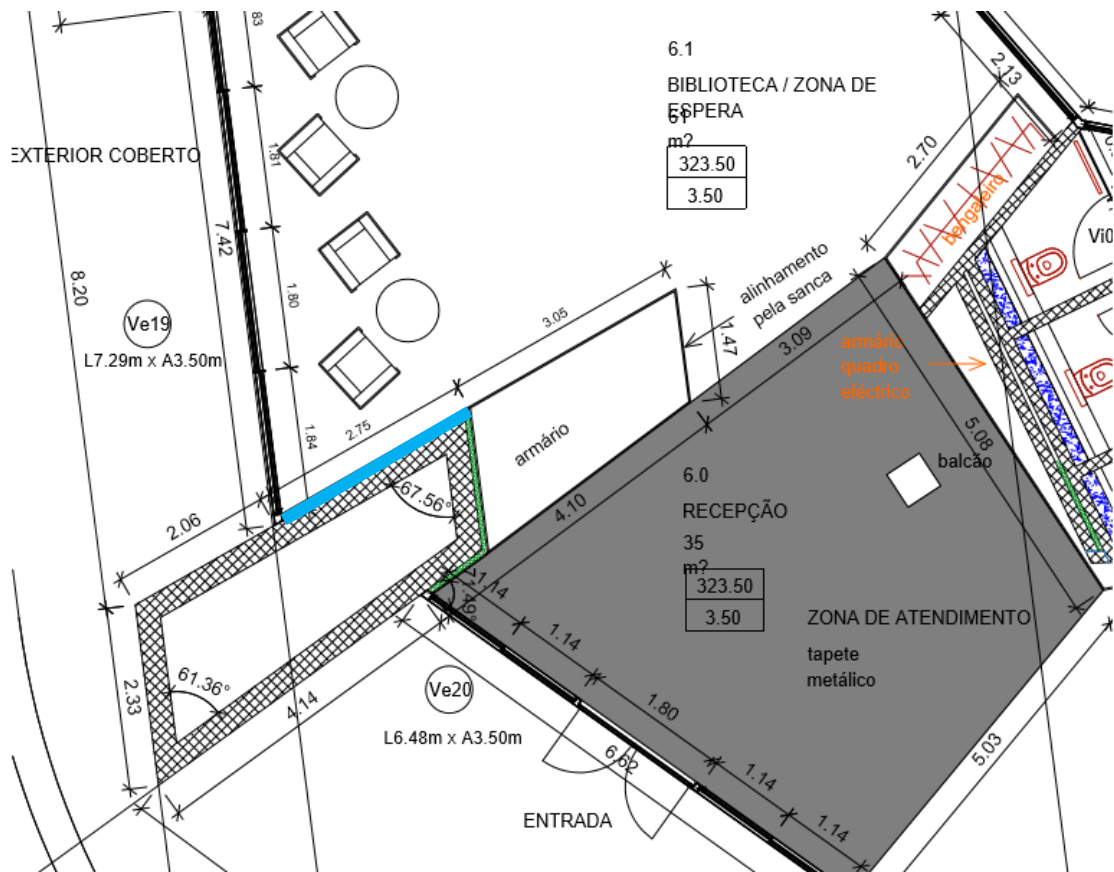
PLANTA DA ÁREA ONDE SE INSERE A MESA E O CANDEEIRO
